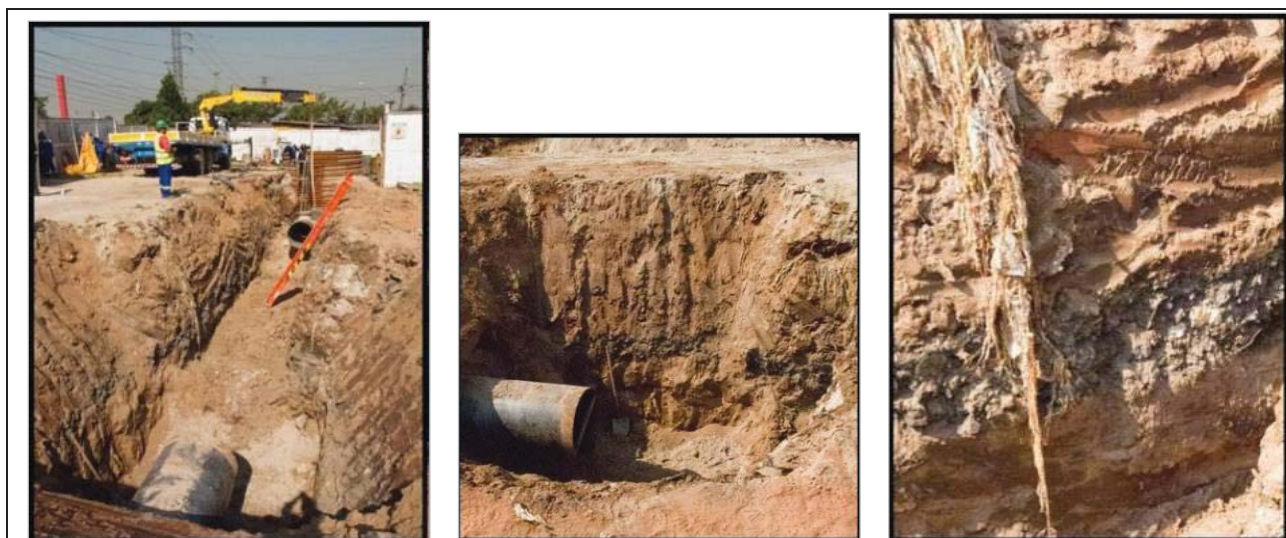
Escavação na área da Estação Goiás, com detalhes do perfil.
